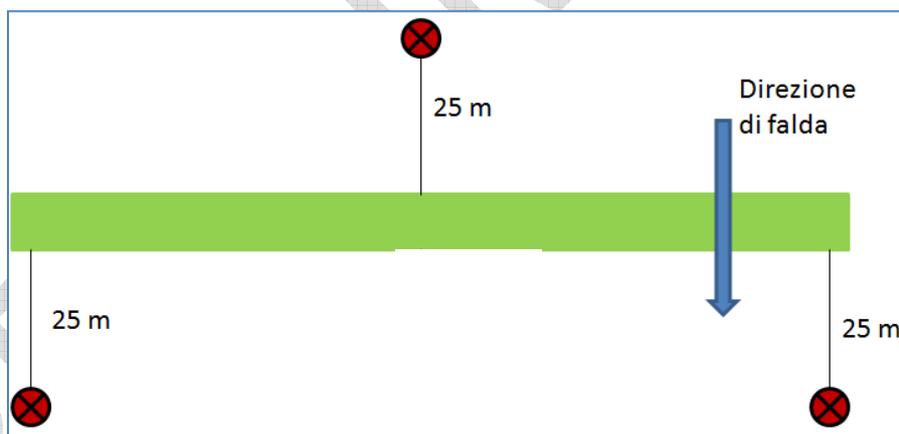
Schema (in pianta) della disposizione dei piezometri (in rosso) rispetto alla galleria (in verde)
